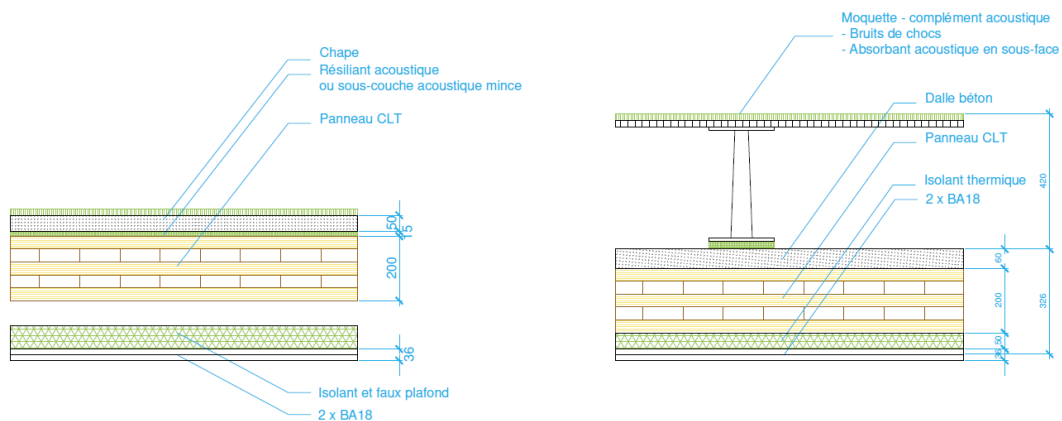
Complexe de plancher – (GAUCHE) Logements ; (DROITE) Bureaux
